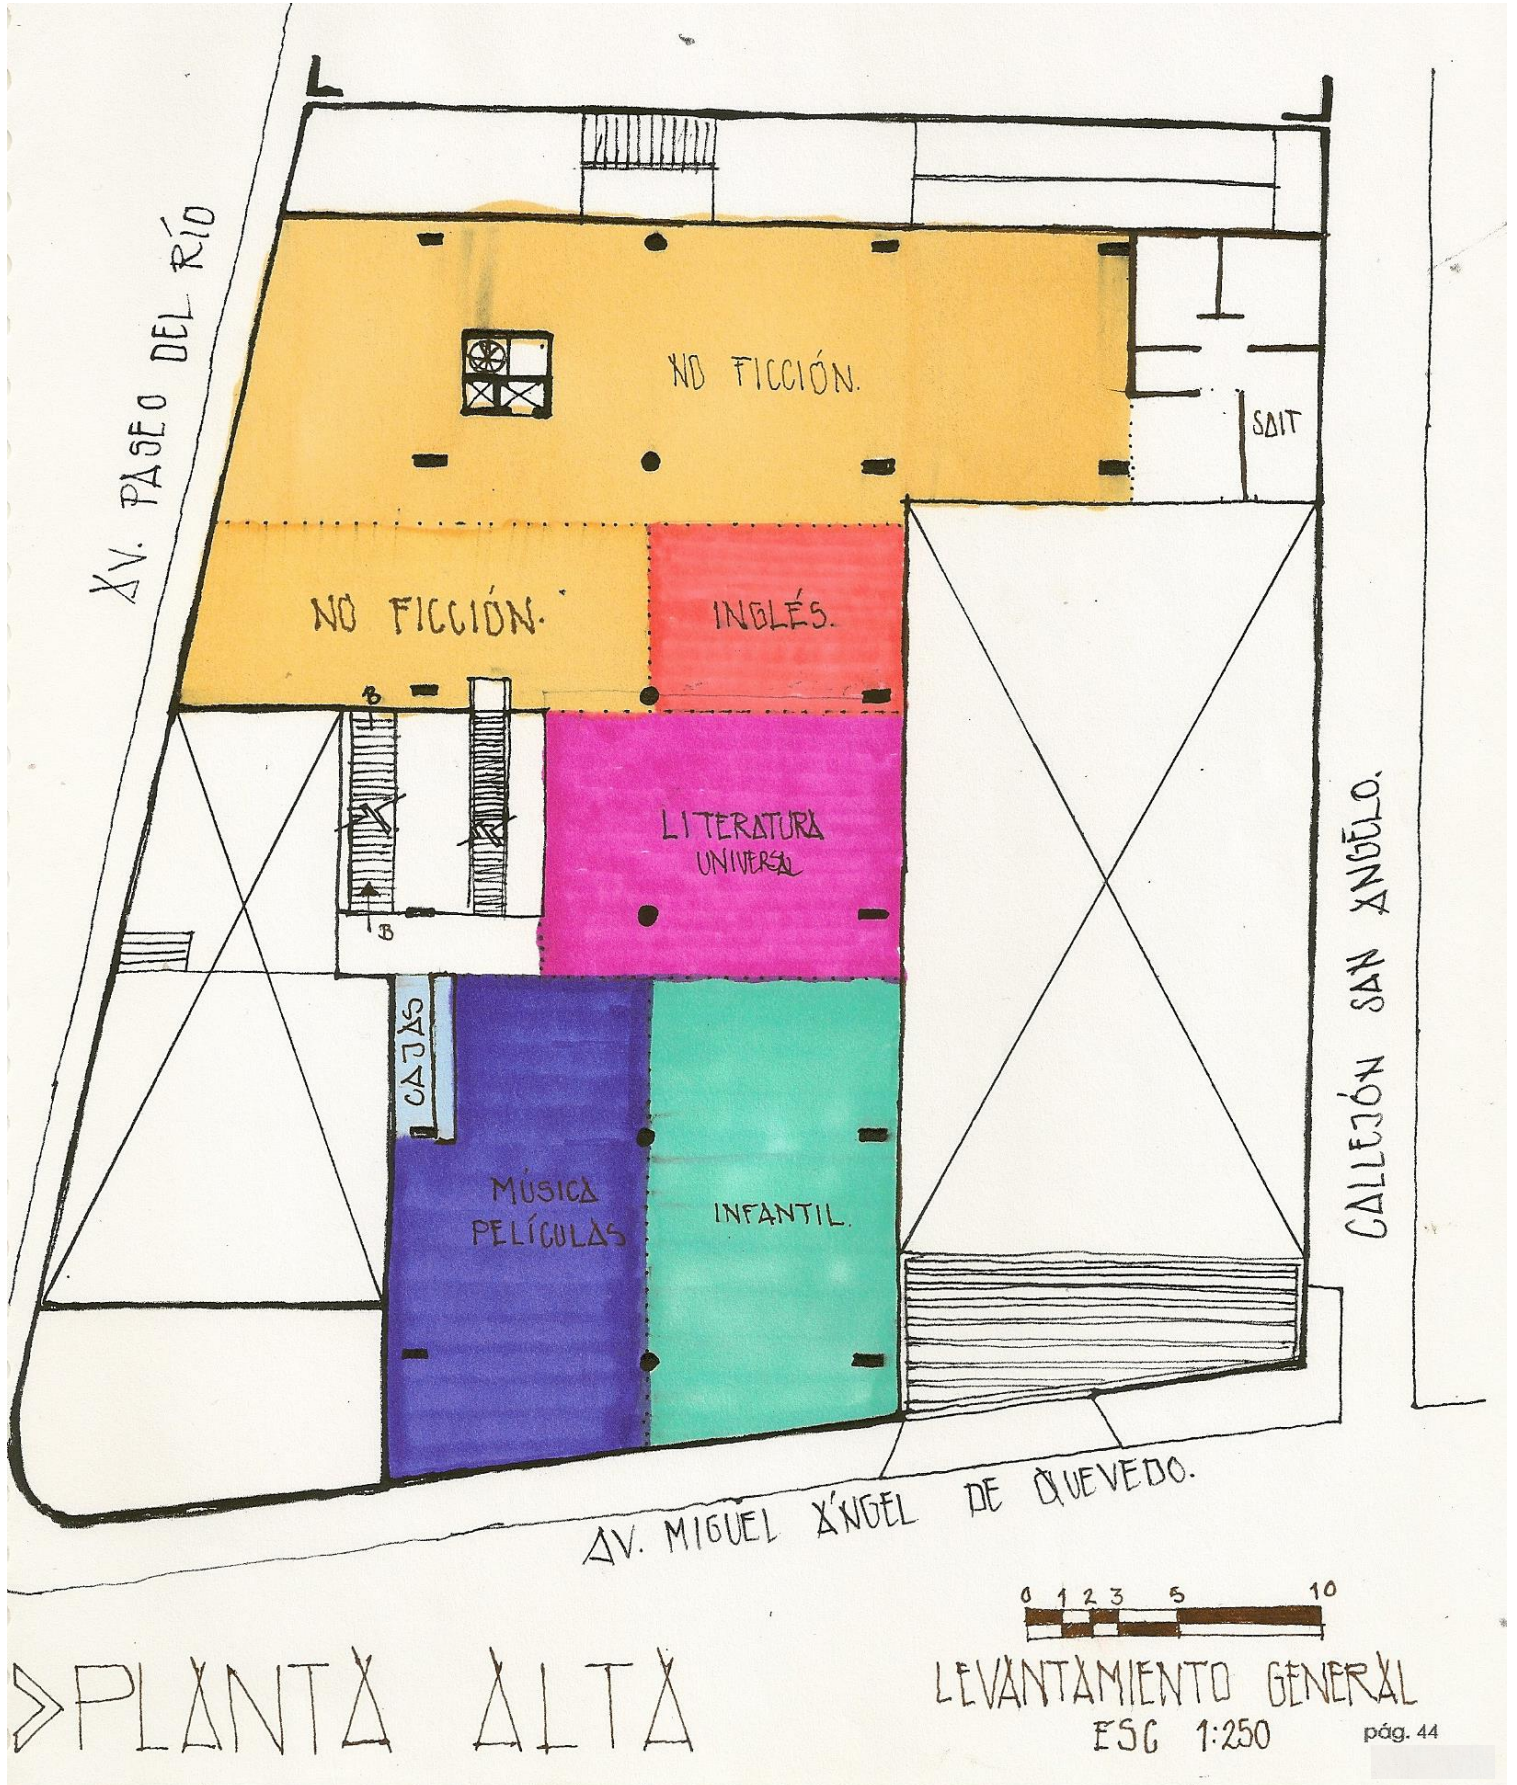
Levantamiento de Sucursal Mauricio Achar, planta alta
